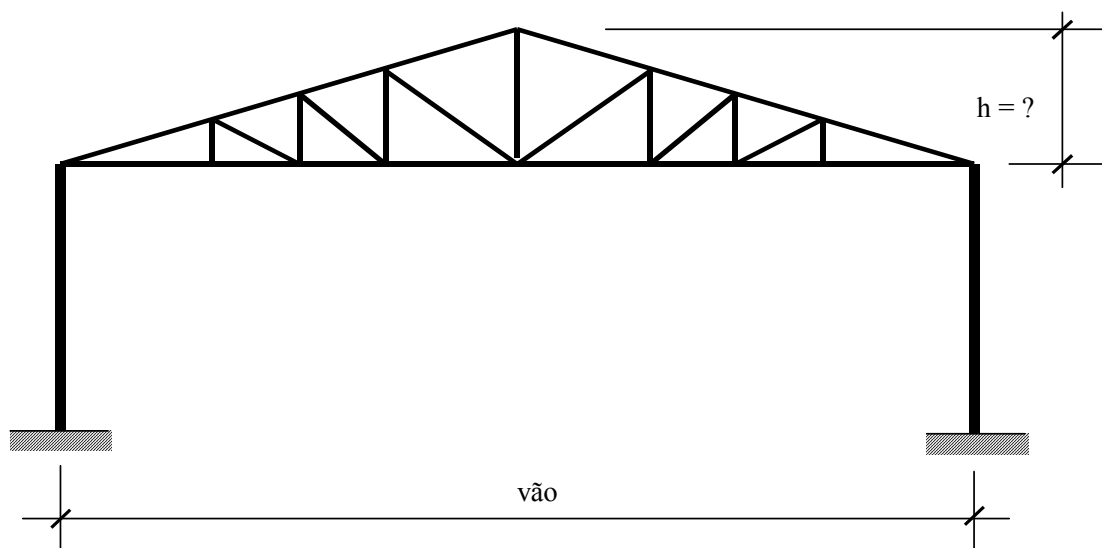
Representação esquemática de uma estrutura de cobertura, formada por estrutura treliçada e pilares.
